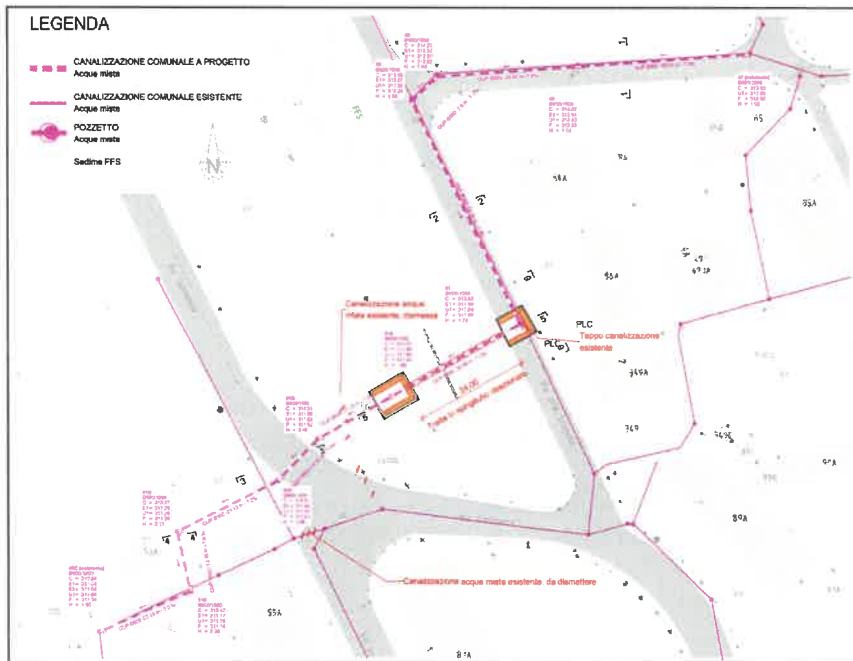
Estratto planimetrico nuovo tracciato acque miste - piano 203 planimetria di progetto
